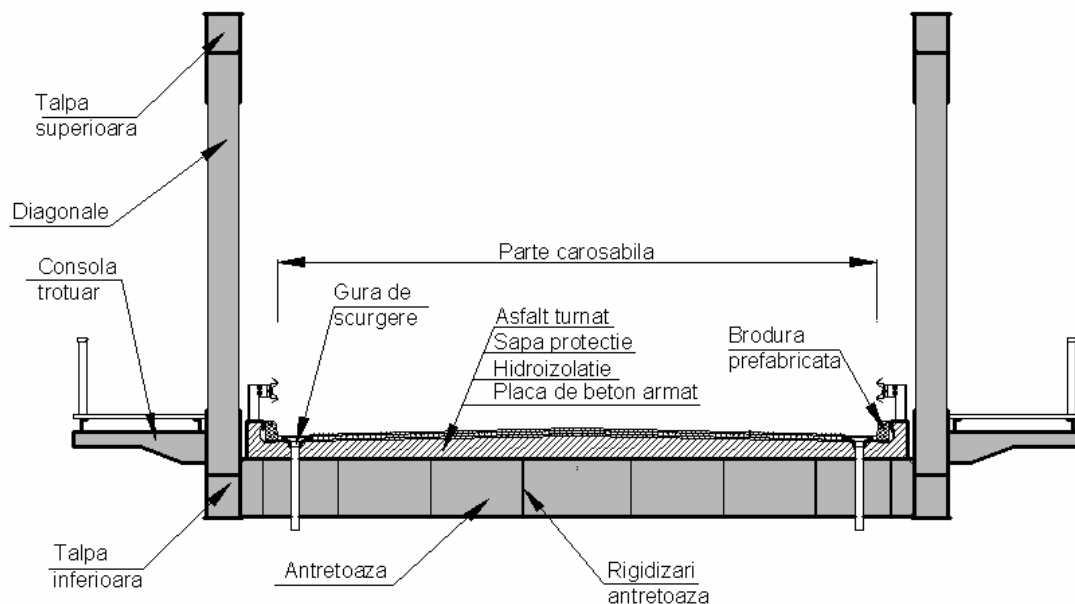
Secțiune transversală prin suprastructura podului de la Merișani
